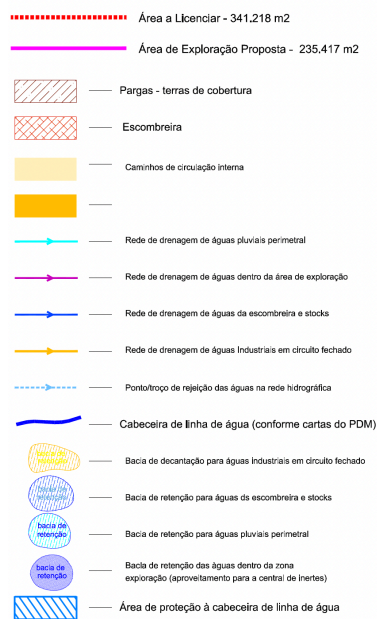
Extrato da planta N2-1 Rede de Drenagem Interna (Plano de Pedreira).
